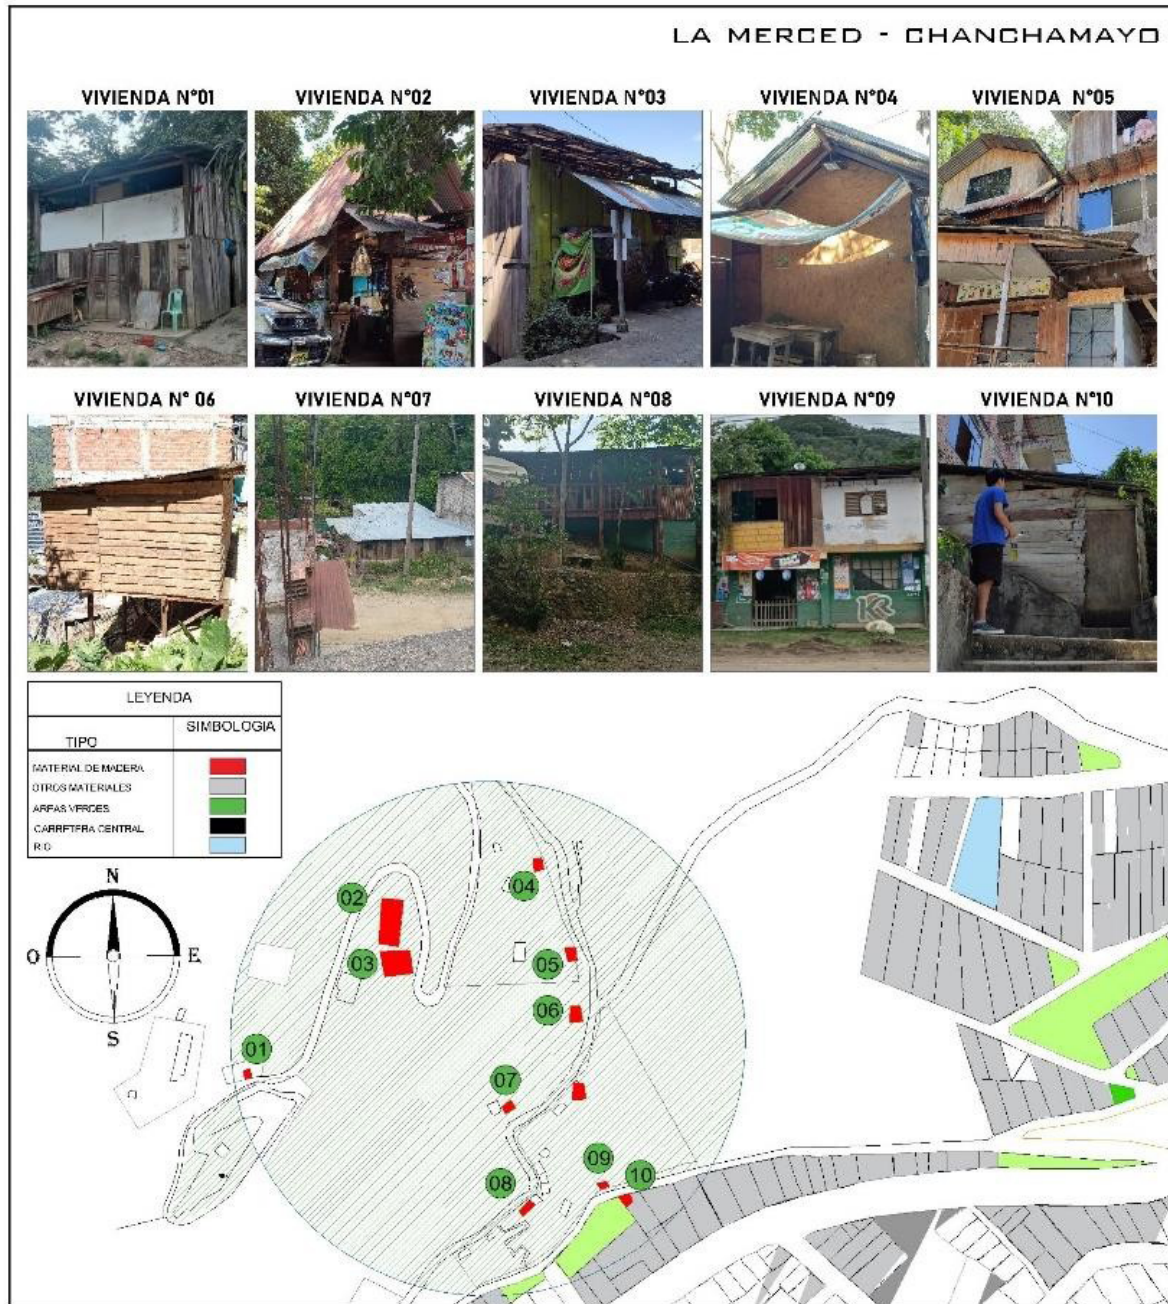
Identificación de construcciones de madera en la Zona Centro: Construcciones informales (de la Vivienda N°01 a la Vivienda N°10).
